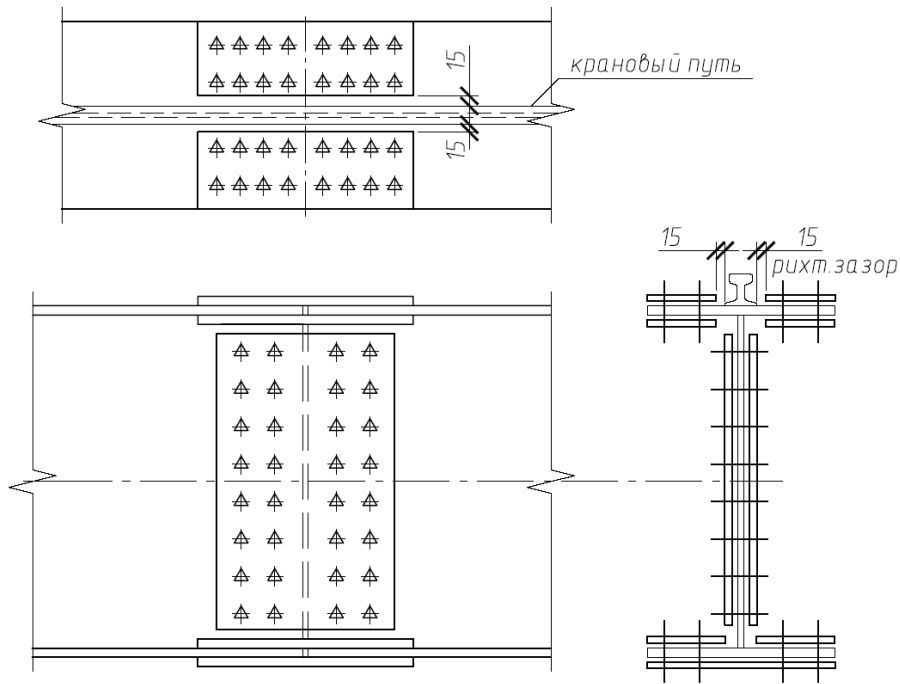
Стык сварной подкрановой балки на высокопрочных болтах
